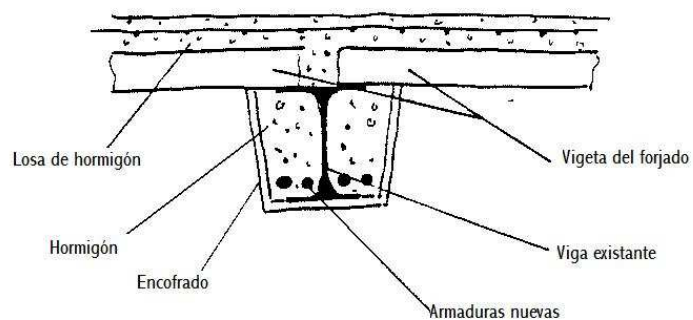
Consolidación de vigas mediante hormigón armado
